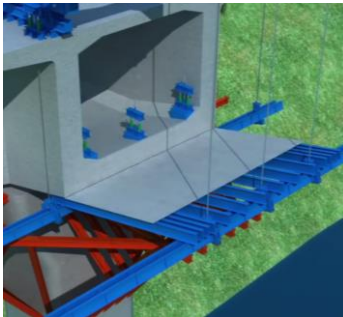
19 Pemasangan *Front Upper Cross Girder
